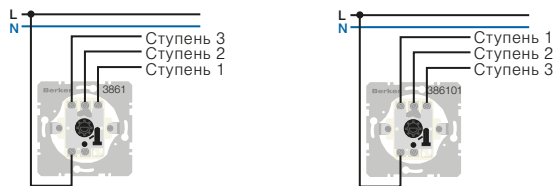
Трехступенчатый выключатель с нулевым положением [№ для заказа 3861]/трехступенчатый выключатель без нулевого положения [№ для заказа 386101]
